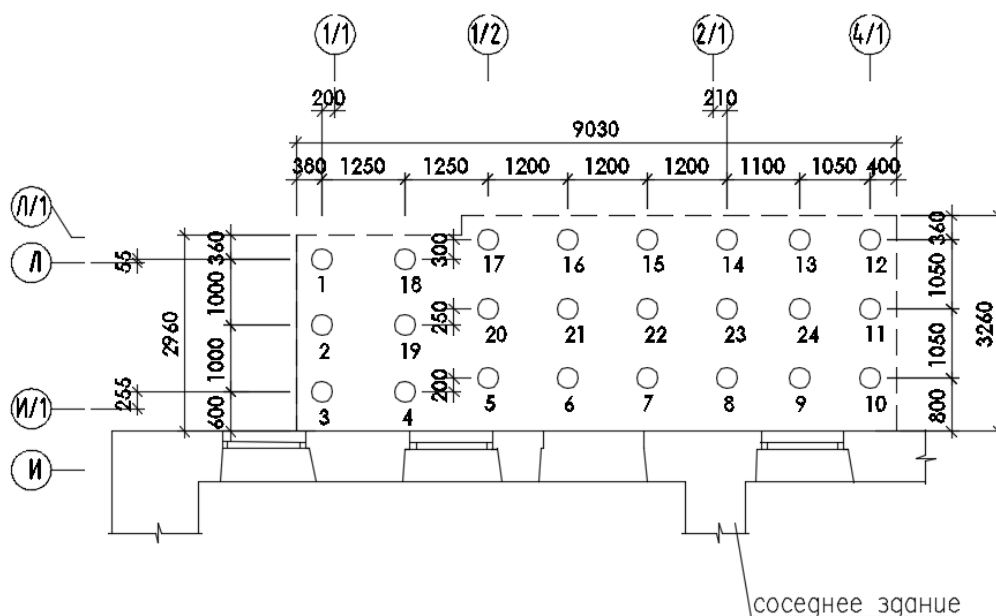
Схема расположения свай на плане плиты двухэтажного здания
